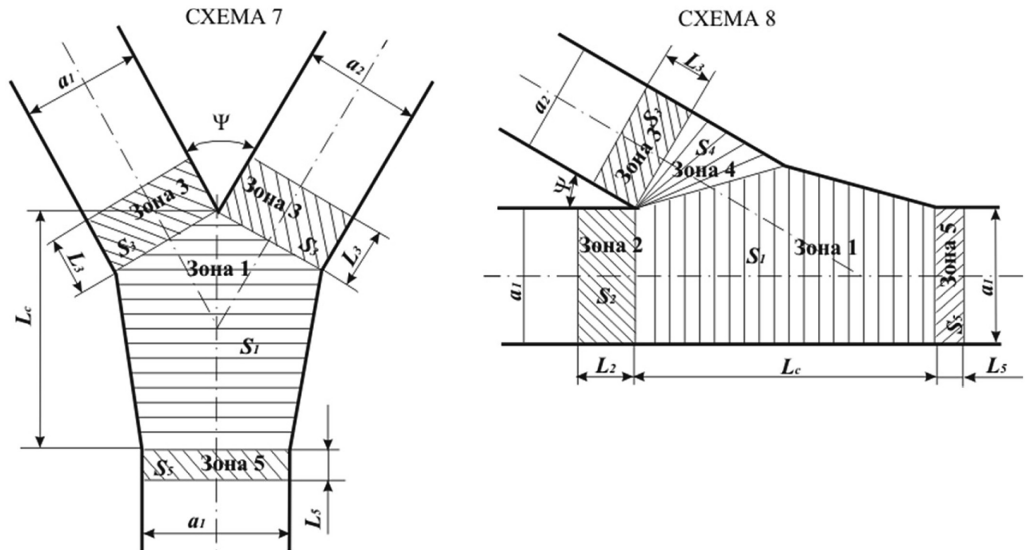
Расчетная схема к определению площади обнажения кровли в различных зонах сопряжения выработок с разветвление и односторонним ответвлением под острым углом
